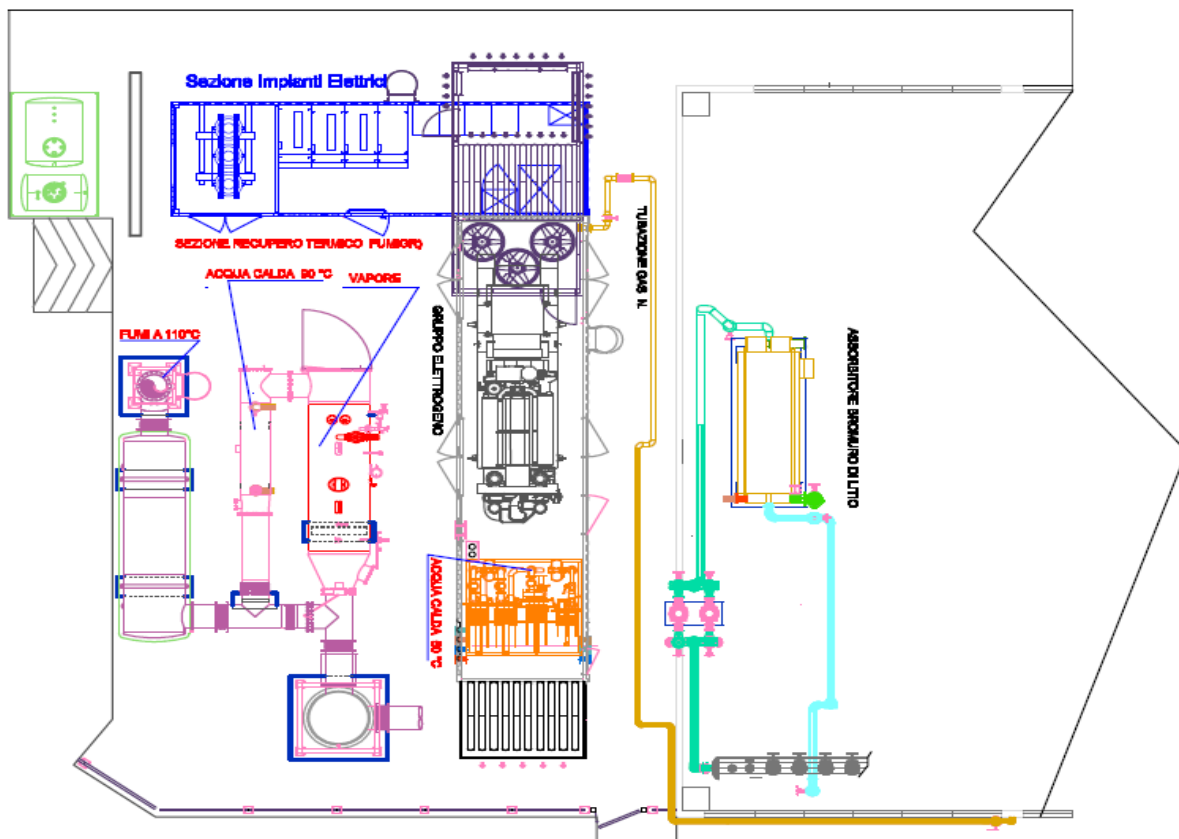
Vista planimetrica dell’impianto di trigenerazione
